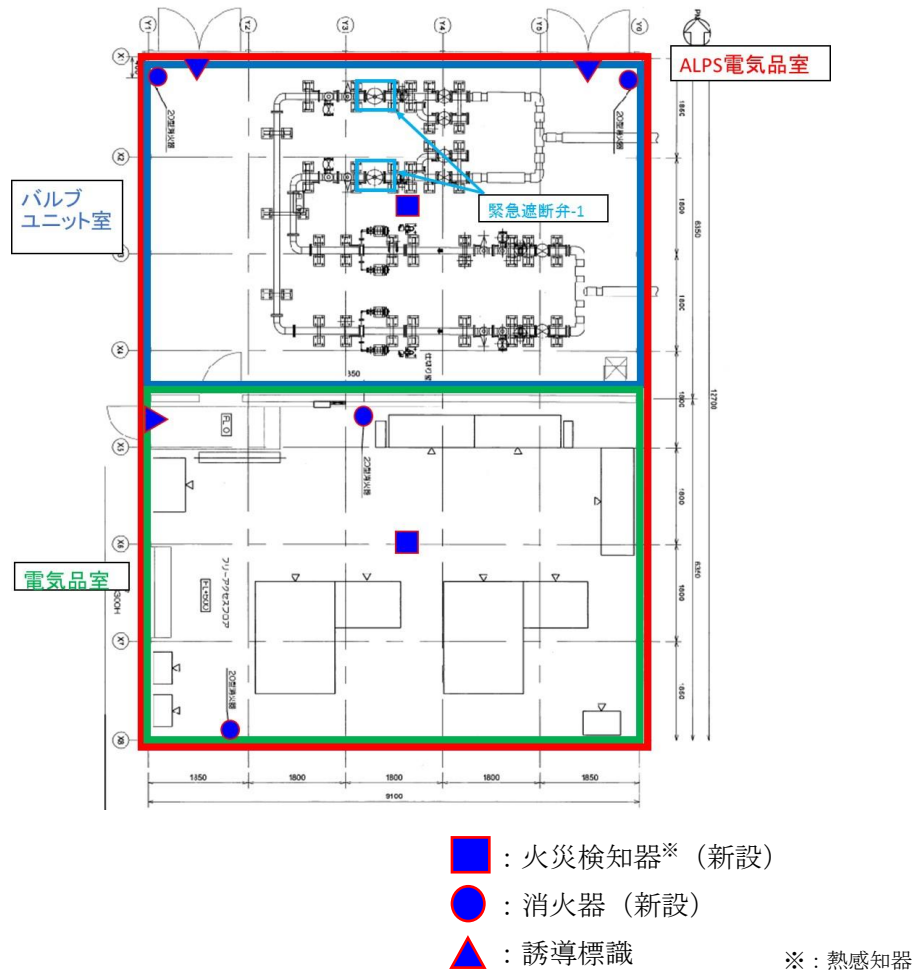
ALPS 電気品室内の機器配置図
